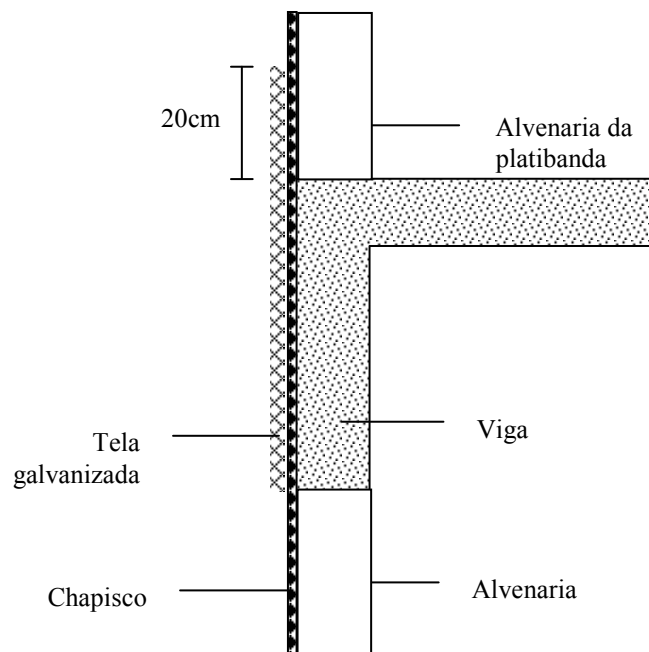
Telamento de encontro alvenaria de platibanda com estrutura (seção transversal).
